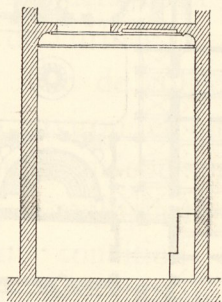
Vitrage en plafond d'une salle haute, n'ayant de vitrines que d'un côté.
